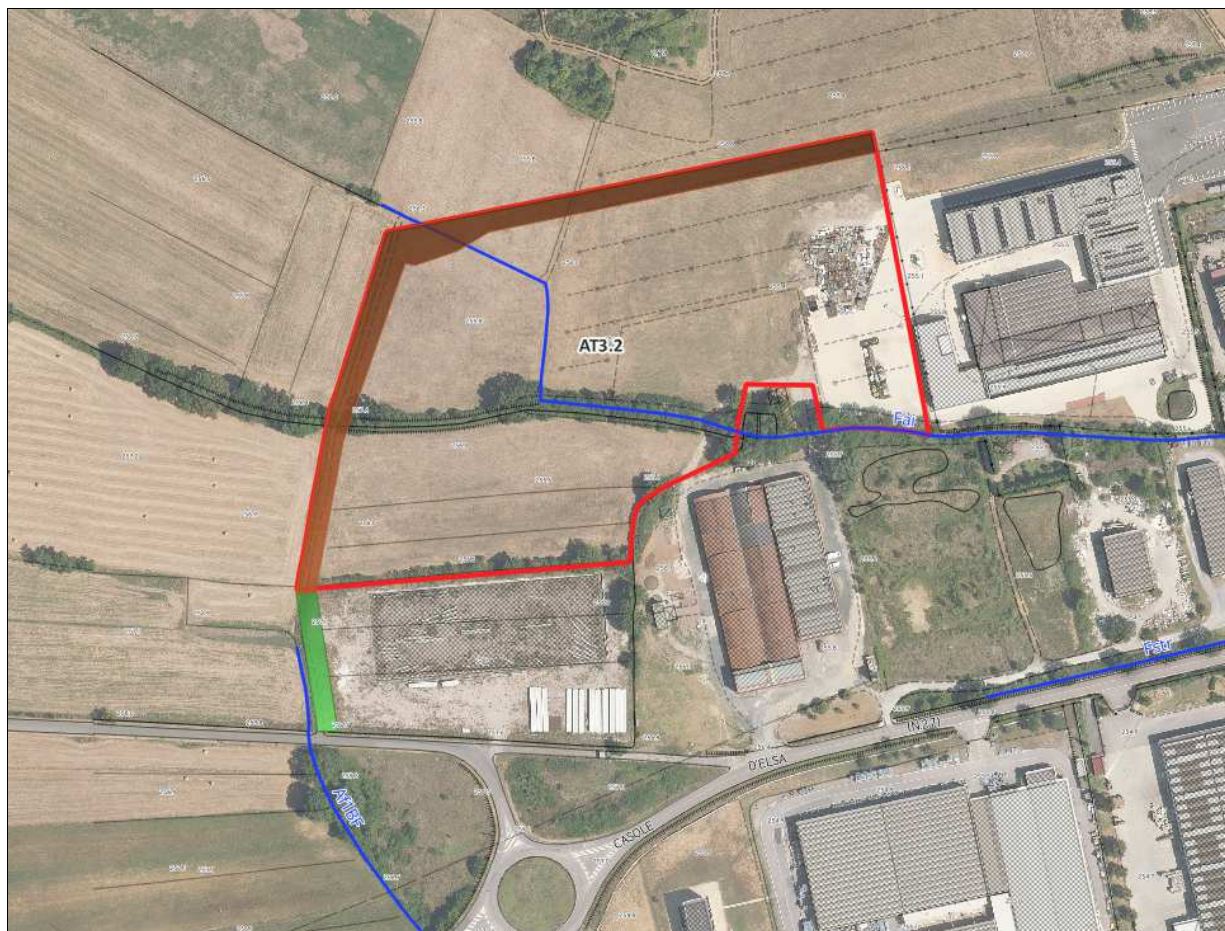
Planimetria dell'argine di protezione di AT3.2
